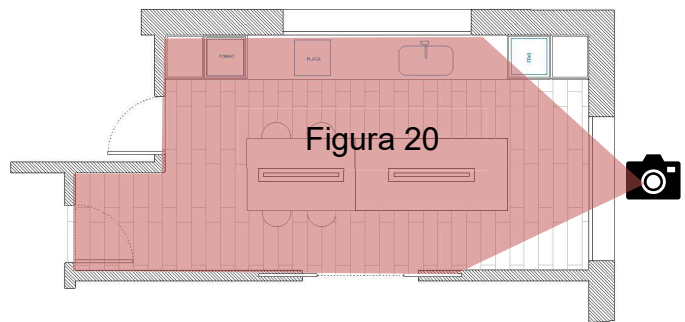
Planta com indicação de vista Cozinha (Projeto AP)
